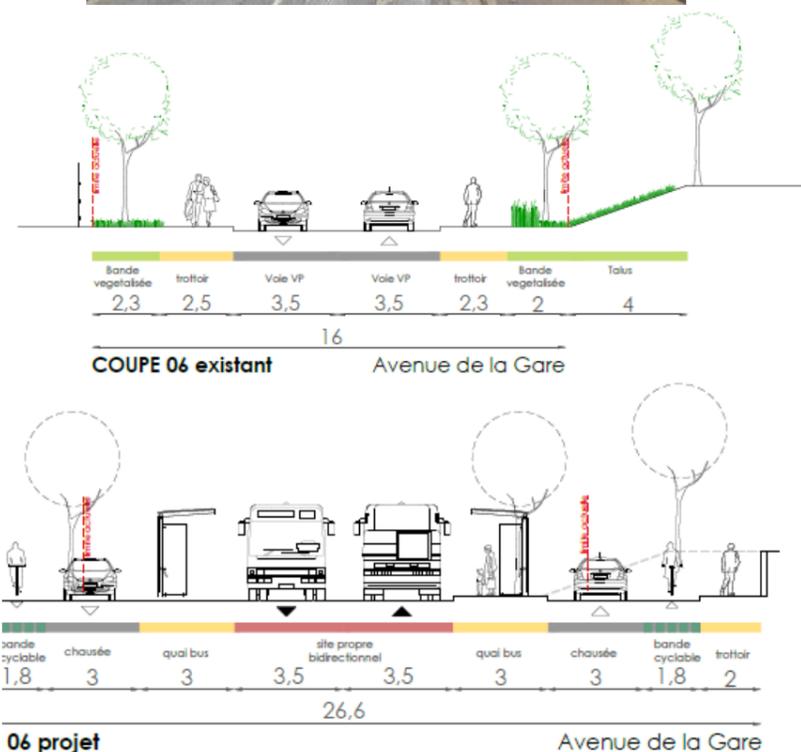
Profil existant et projeté sur l'avenue de la Gare - Station Rond-point de l'Europe
